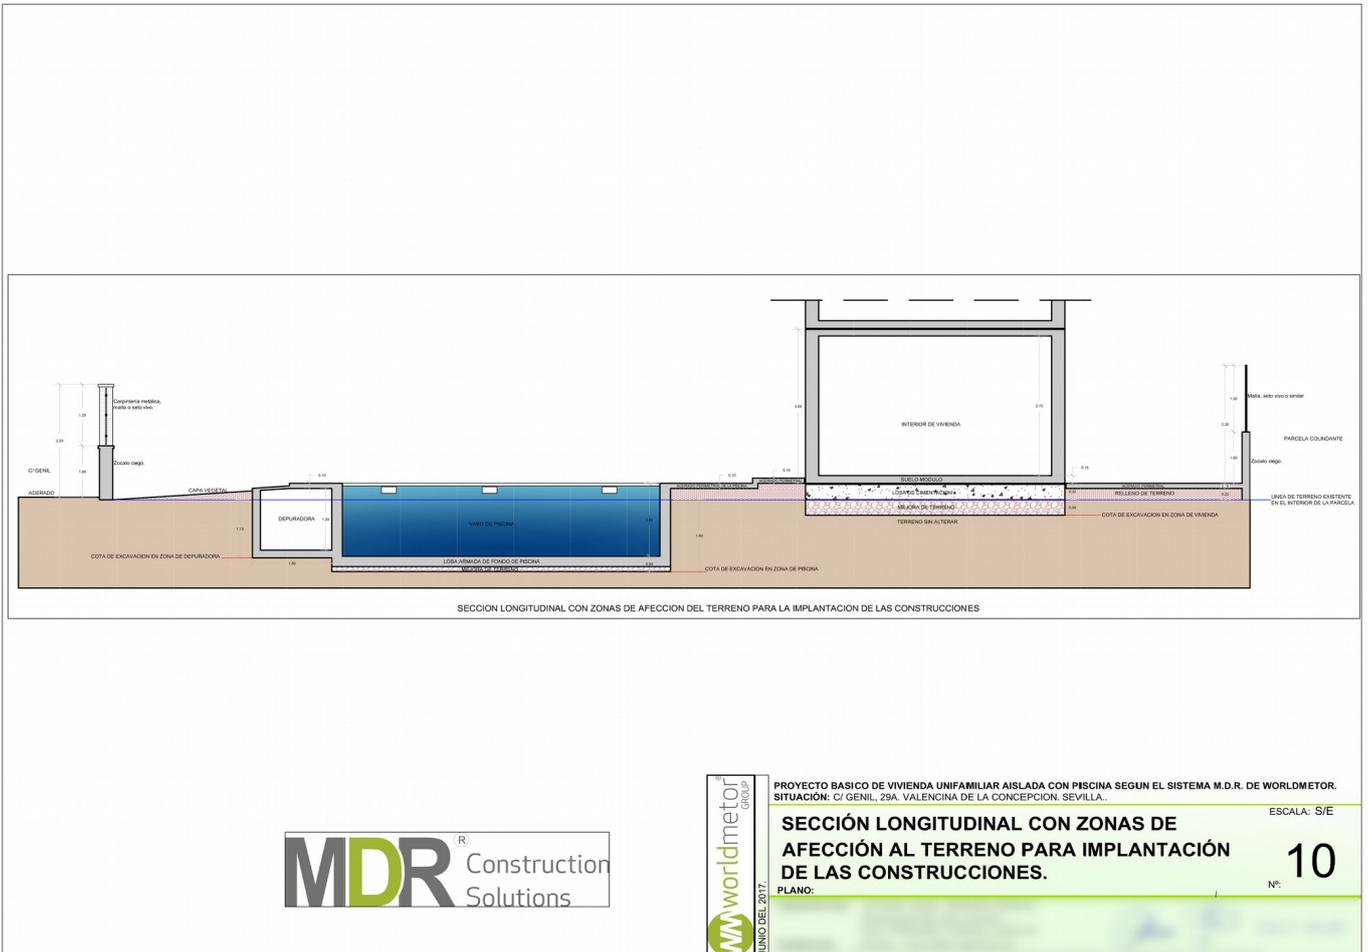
Sección longitudinal con zonas de afección al terreno para implantación de las construcciones.
